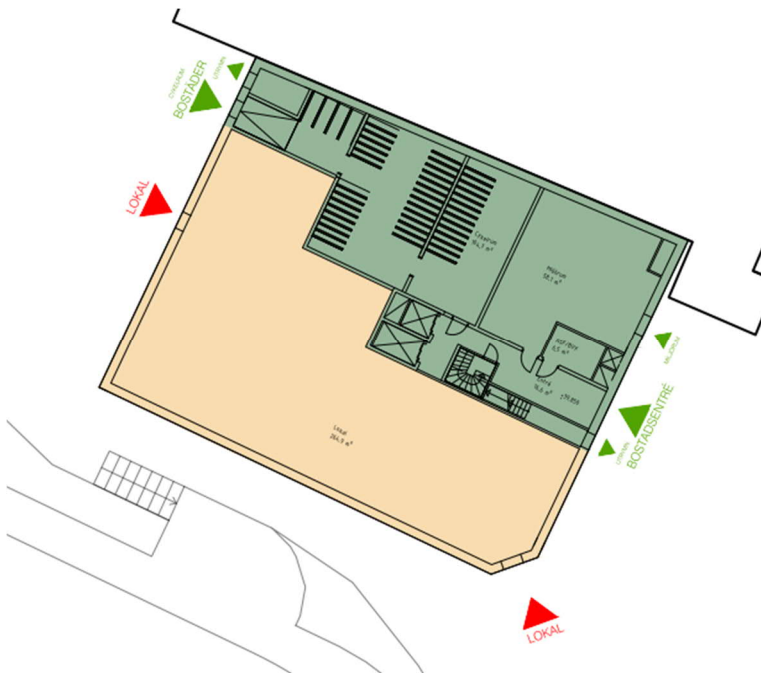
Övre garageplan i kvarter Önskehemsplan. Illustration 2024-03-18.
